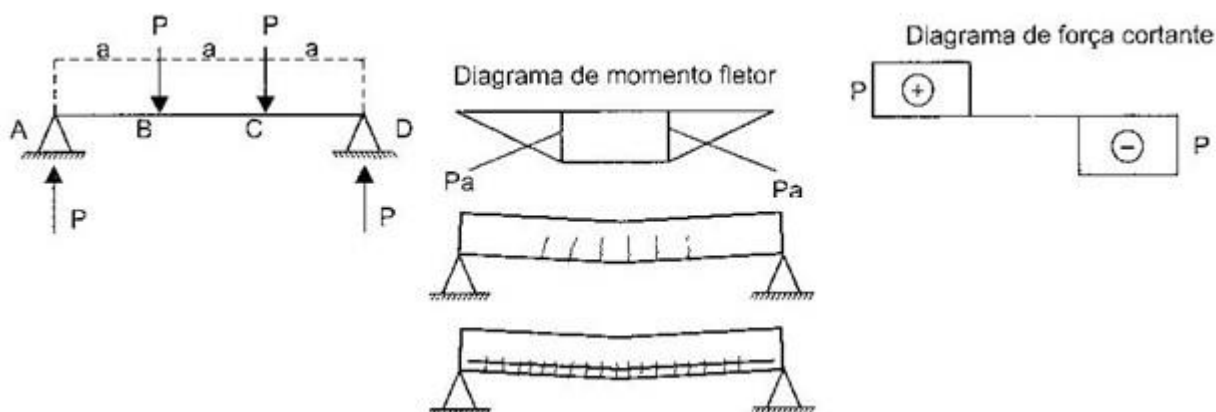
Comportamento de uma viga de concreto simplesmente apoiada Fonte: Carvalho; Filho, 2016.
